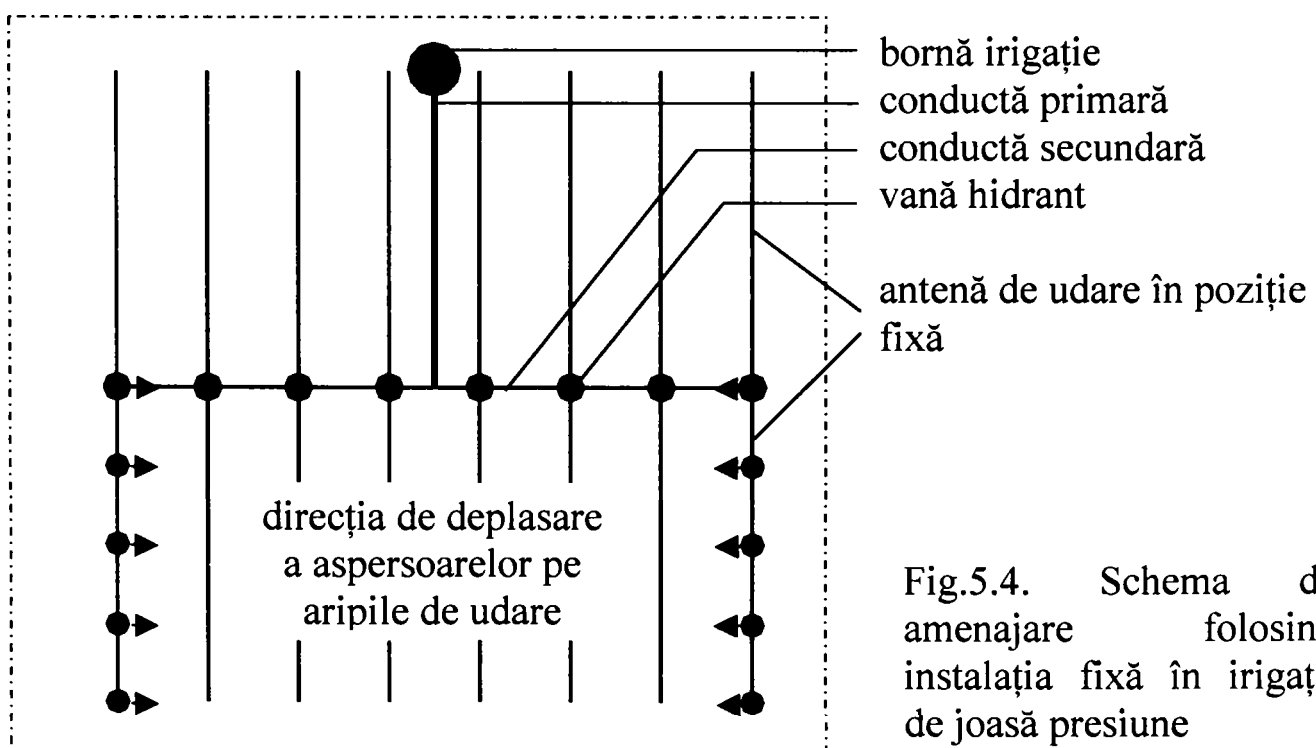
Schema de amenajare folosind instalația fixă în irigații de joasă presiune
